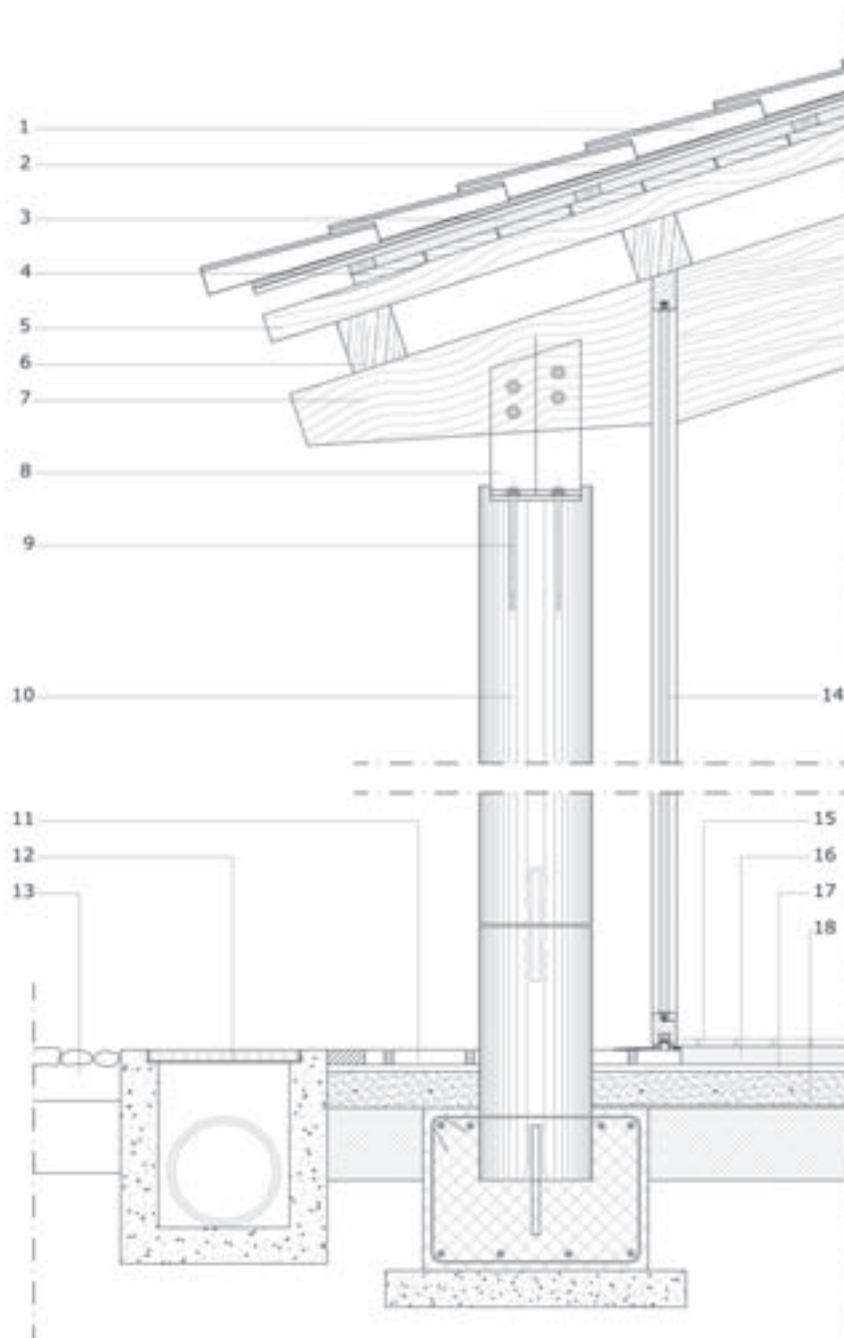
Dettaglio costruttivo. Sezione verticale in corrispondenza delle vetrata delle sale espositive a est delle corte.
